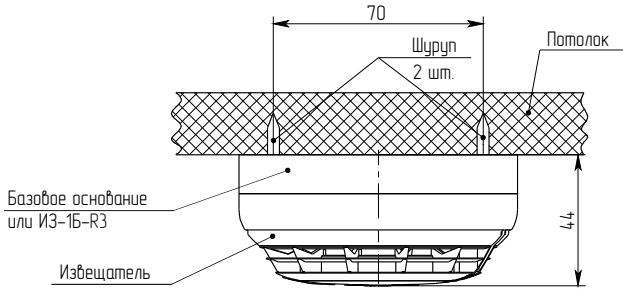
Установка извещателя на потолке с базовыми основаниями W1.02, W1.03 или ИЗ-1Б-РЗ
